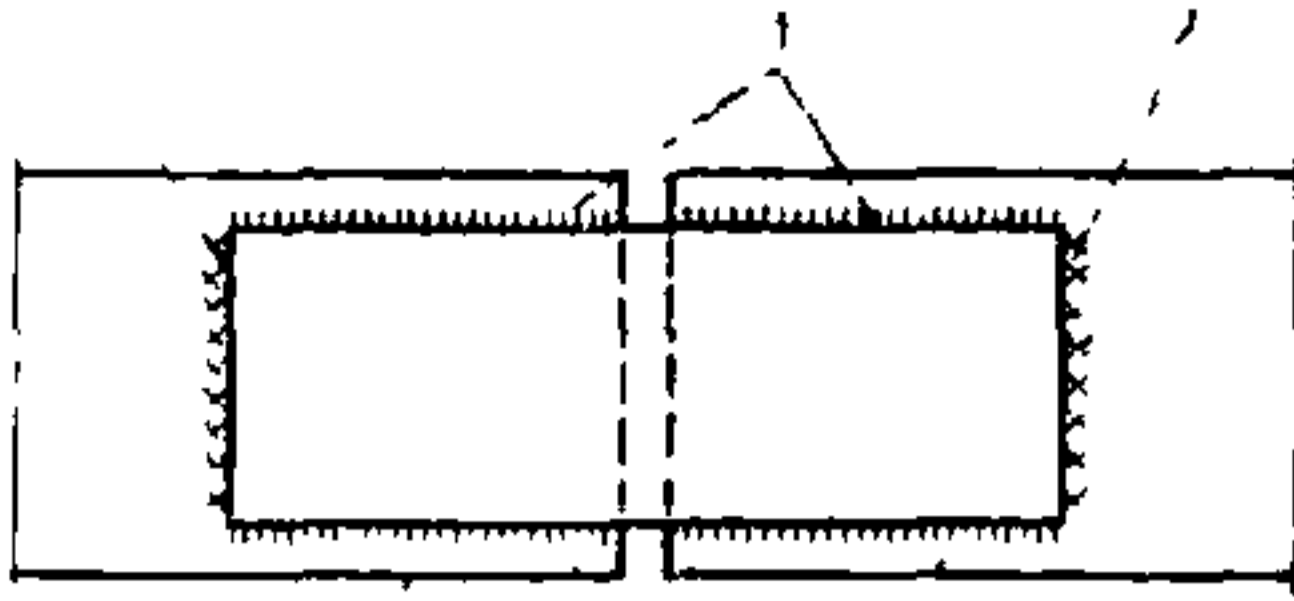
Усиление сварного соединения доваркой лобовых швов
